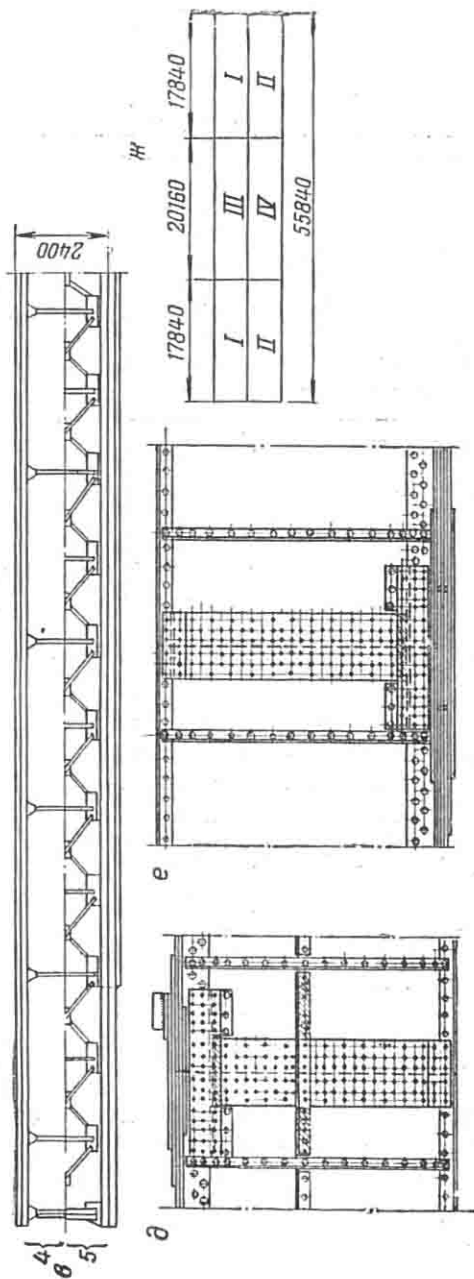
Блочное клепаное пролетное строение длиной 53,0 м со сплошной стенкой с едой поверху на балласте:
